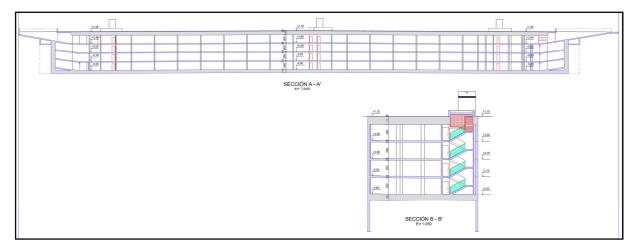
"Aparcamiento Bajo Rasante. Secciones". Fuente: el autor.
